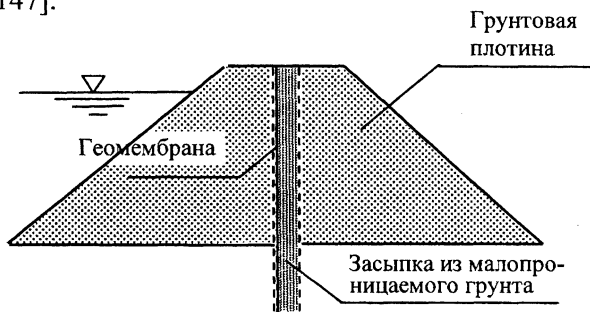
Гидроизоляция грунтовой плотины с помощью геомембраны
